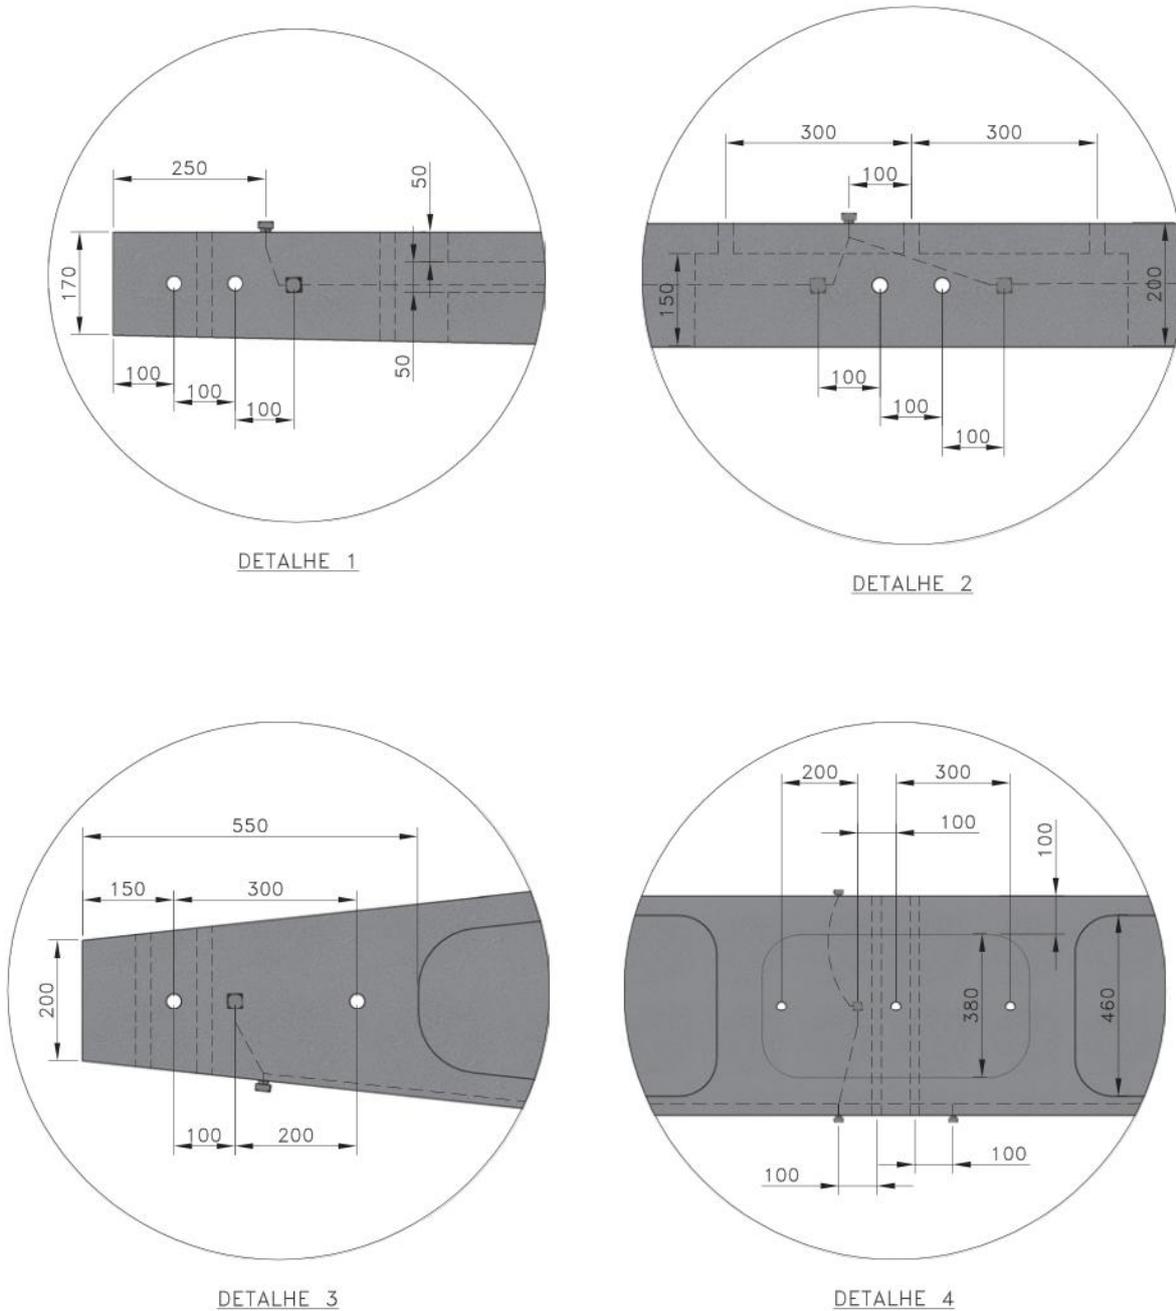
Cruzeta de concreto armado especial - tipo "H" – 6700mm - detalhes
